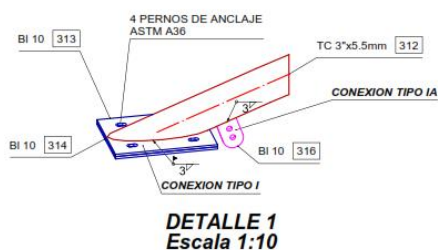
Detalle de anclaje de estructura metálica para cubierta Aula Multiservicio. Fuente: Planos proyecto
